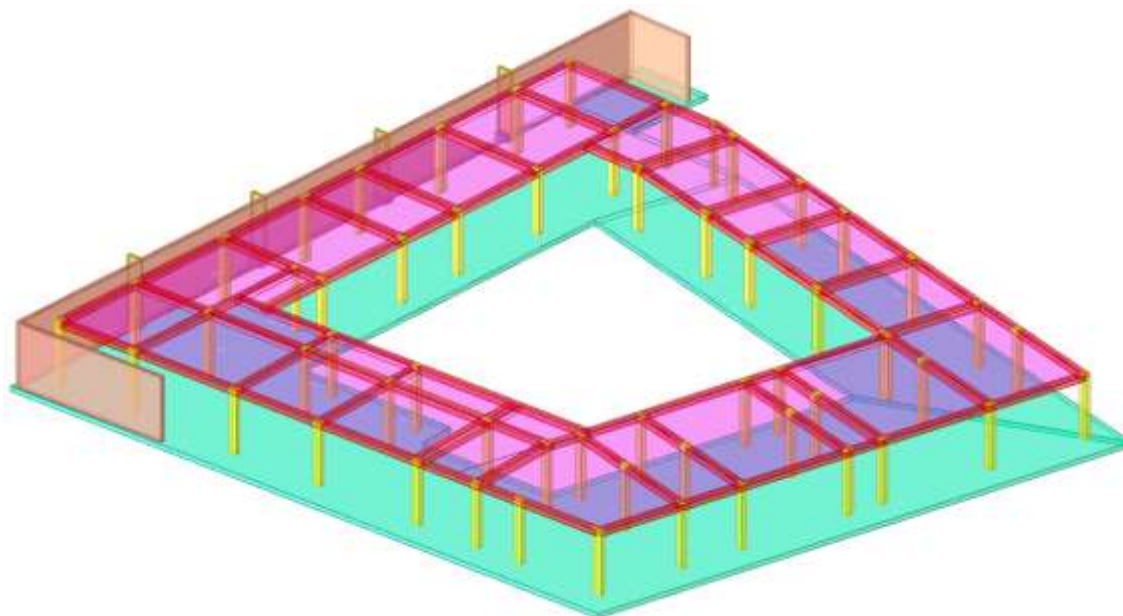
Strutture a telaio in C.A. dell'Asilo
